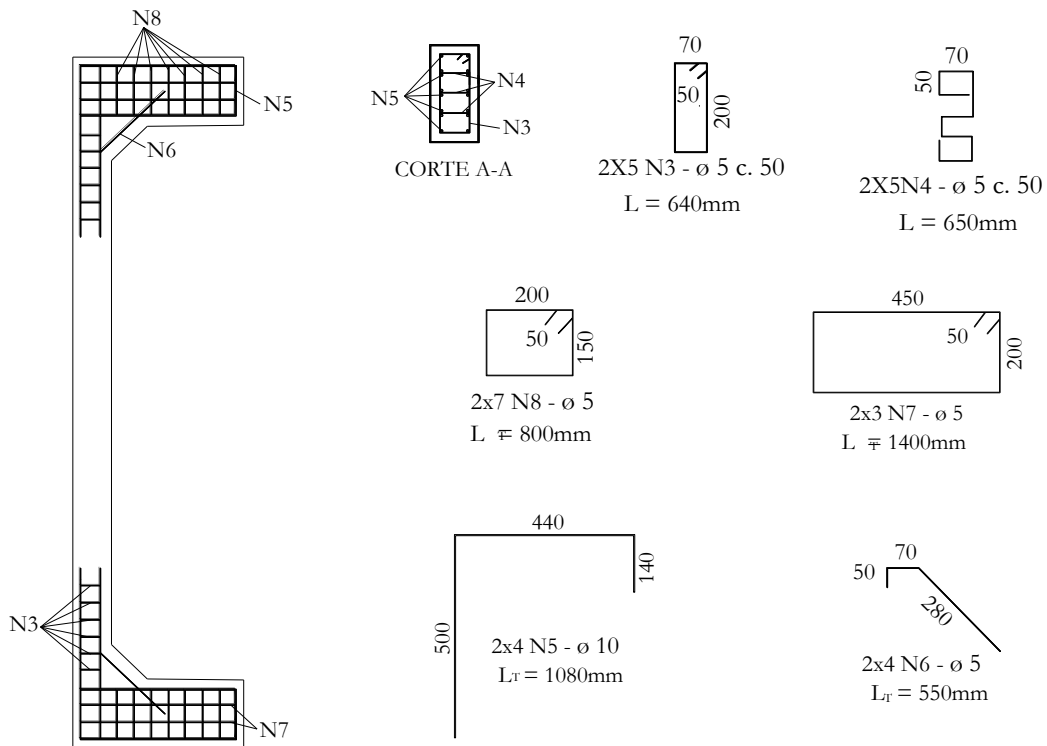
Detalhamento das armaduras da Série 1 (ARAÚJO, 2004)
